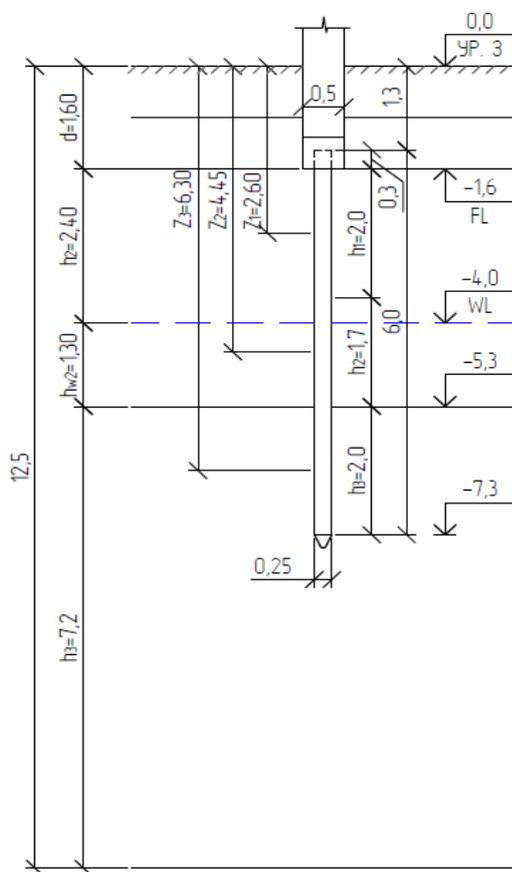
Проектное расположение сваи-фундамента в грунтовом покрытии основания конструкции
